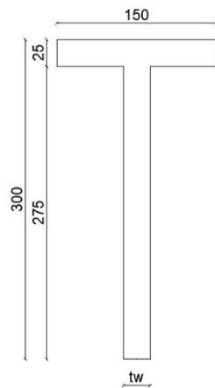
Sezione tipo della trave a T (misure in mm)
